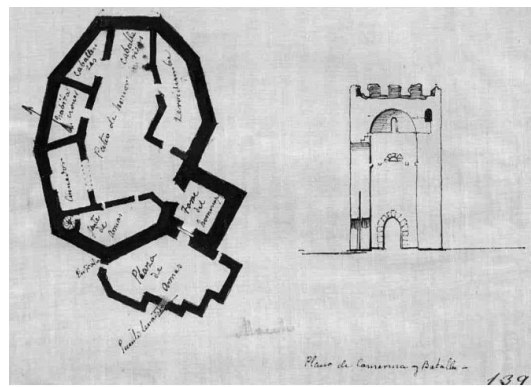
Planta del Castillo de Moeche, Parroquia de San Xurxo, Ferrol, A Coruña. Posee planta poligonal que en la parte oeste esta defendida con un foso excavado en la roca, hacia el este la entrada defendida con un baluarte añadido de planta irregular. Con torre del homenaje de 18 m de altura y planta cuadrada en uno de los lados del recinto. Siglo XIV. Balsa de la Vega, Rafael. Catálogo Monumental y Artístico de la provincia de La Coruña. Tomo II., Diputación provincial, A Coruña, 1991, Lám. 139.
